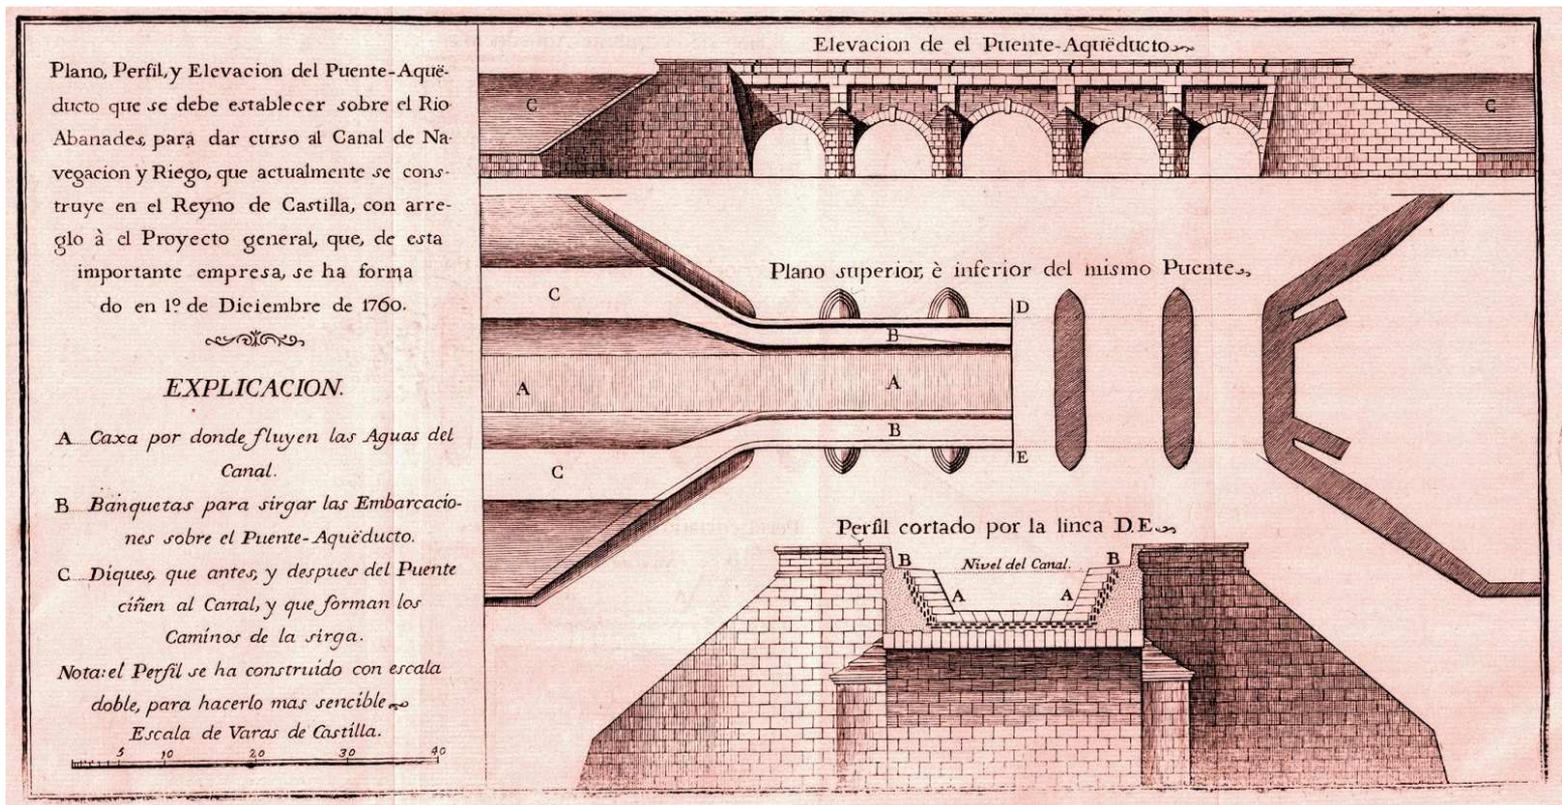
Plano, perfil y elevación del Puente-Acueducto
